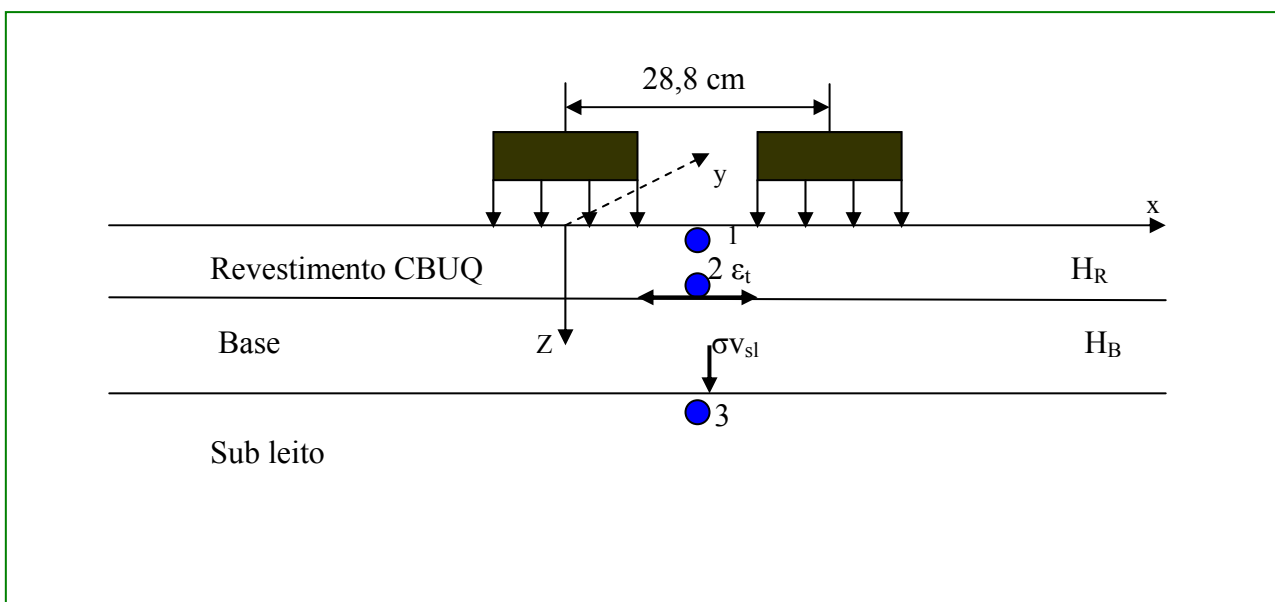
Croquis da estrutura de pavimento em estudo.
